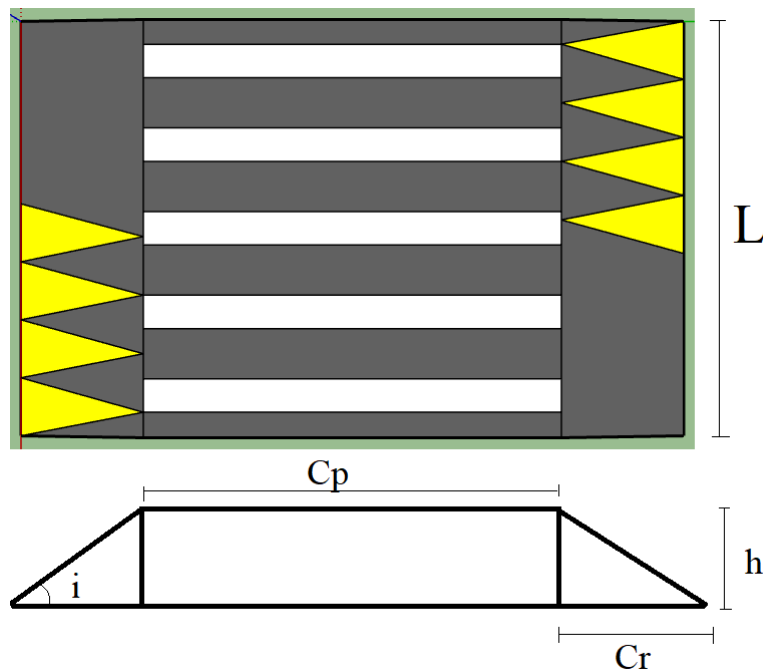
Vista superior e corte esquemáticos dos parâmetros geométricos e sinalizações horizontais de uma faixa elevada.
